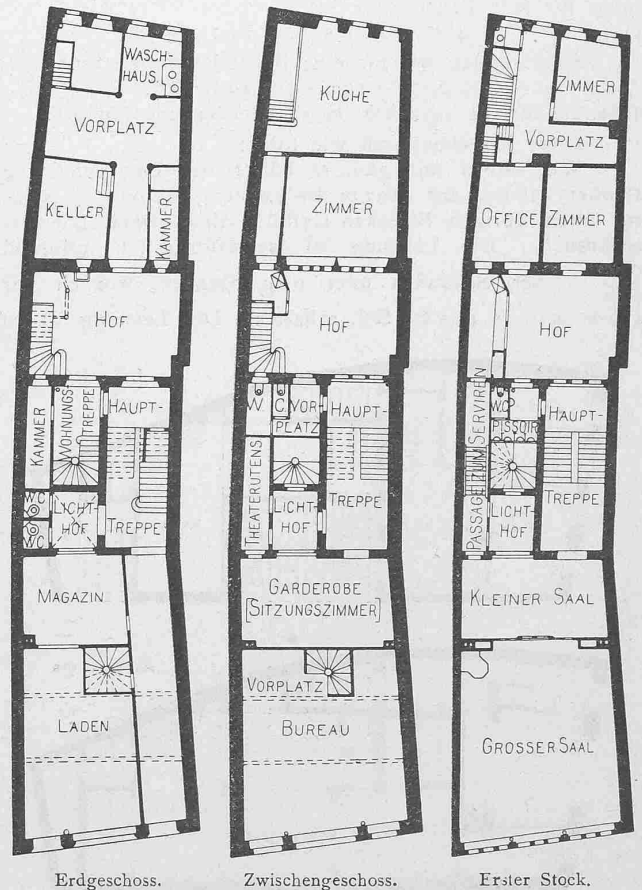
«Zunft zu Hausgenossen». — Grundrisse. — 1:400.
